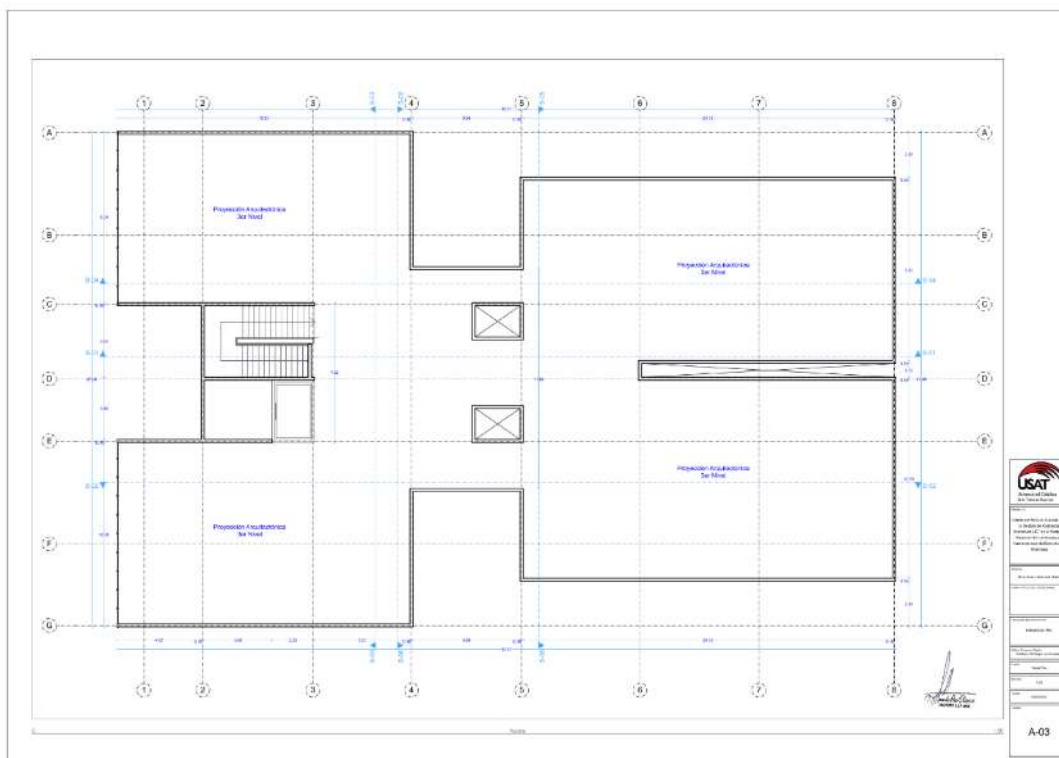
Planta Arquitectónica del Nivel de Azotea
